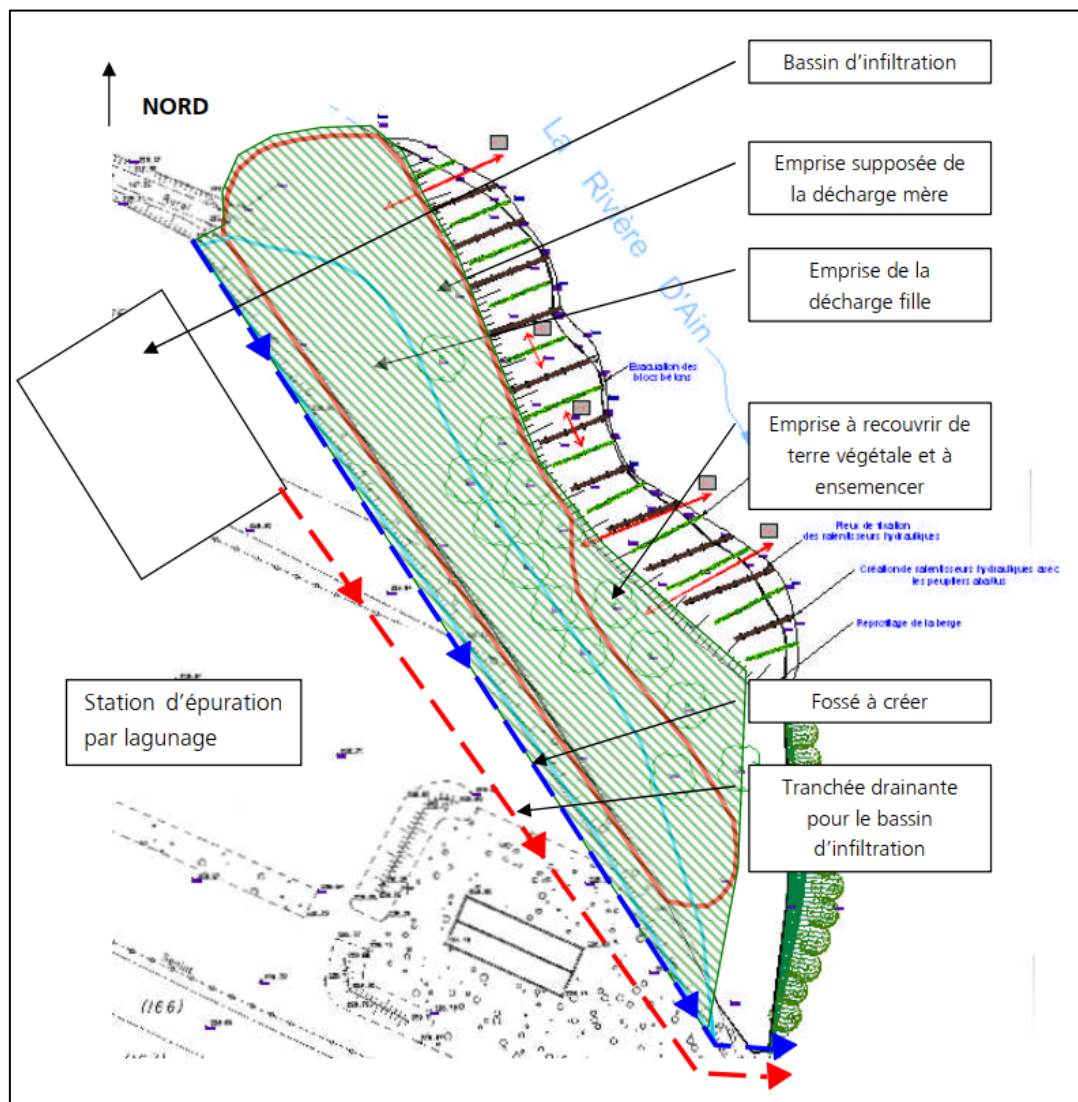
plan des travaux proposés – source : CSD Azur 2009
